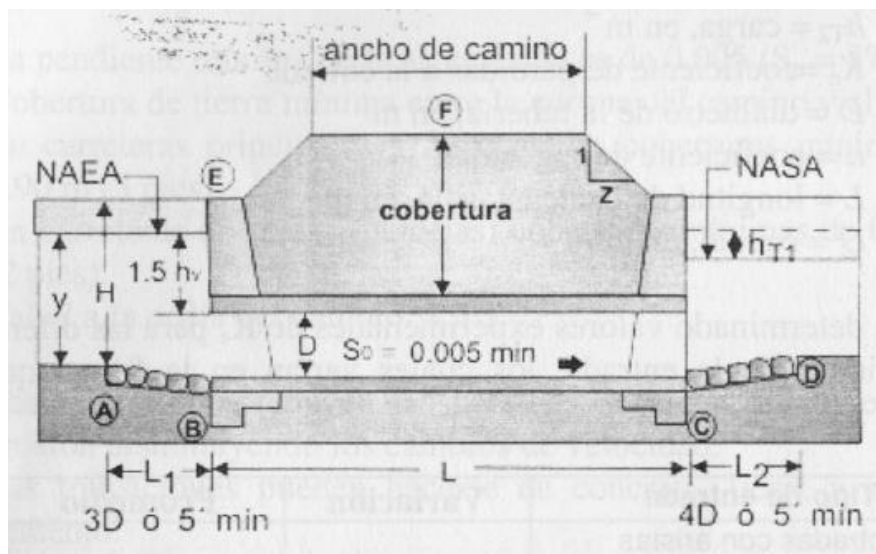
Parámetros para el diseño de las alcantarillas de pozo
